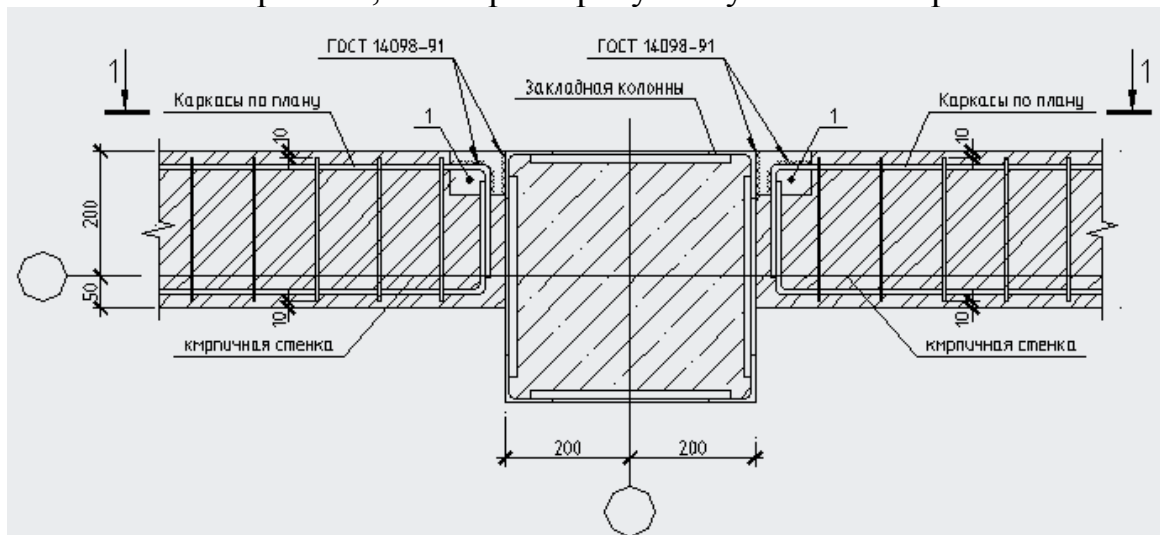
Крепление каркасов кладки к колоннам
